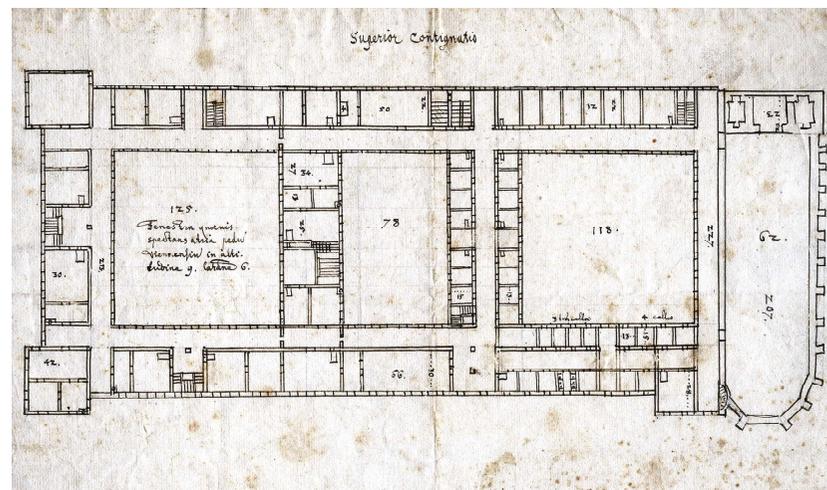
Grundrissplan des Stiftes St. Lambrecht von P. Gabriel Bucelin (Foto: Ernst Reichenfelder, St.A Admont).
